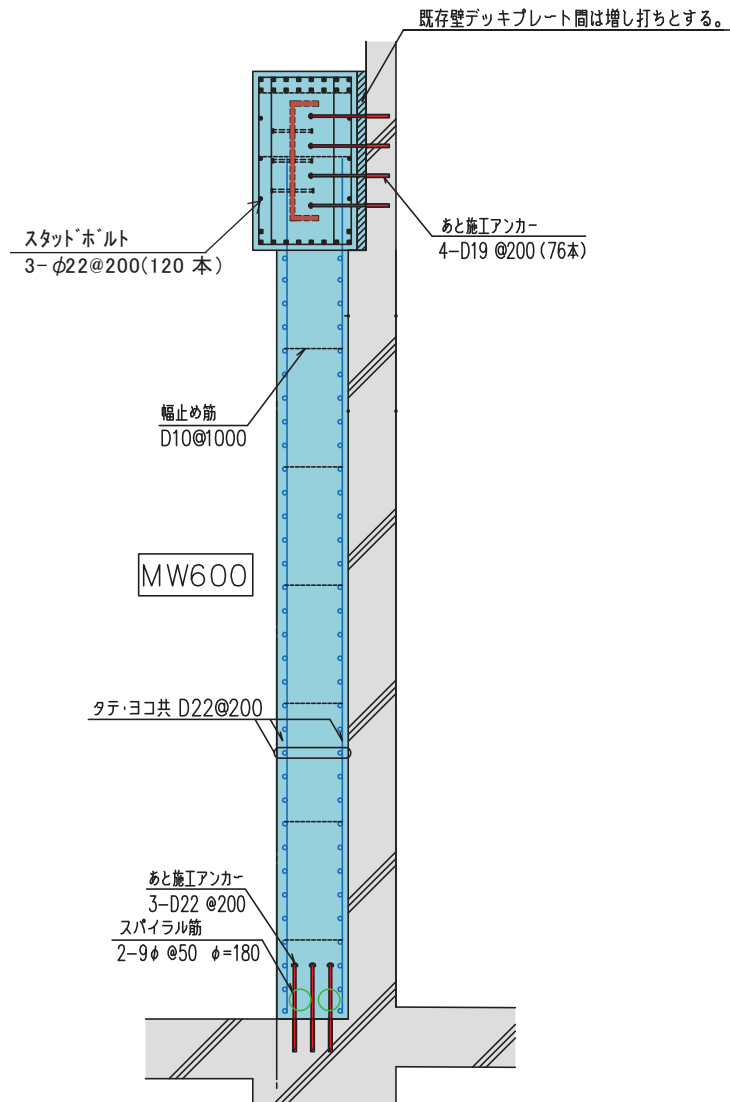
追設耐震壁配筋詳細 (A-A 断面図)
